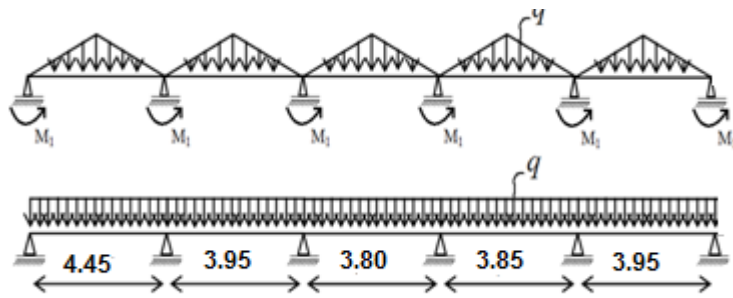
Schéma statique de la poutre secondaire.
